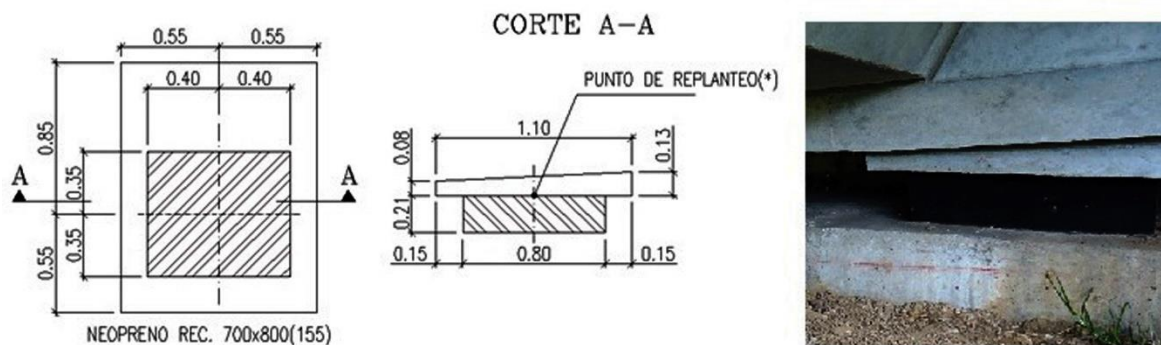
Esquema de apoyos en estribos. Fuente: tomado de planos de construcción, cortesía Pedelta Colombia S.A.S.
